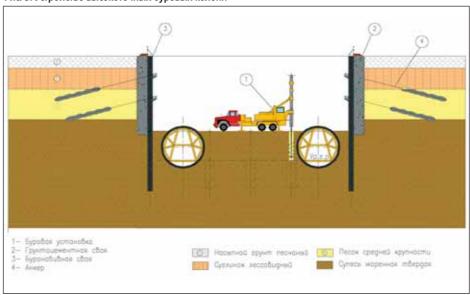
Устройство крепления котлована грунтоцементными буронабивными сваями
